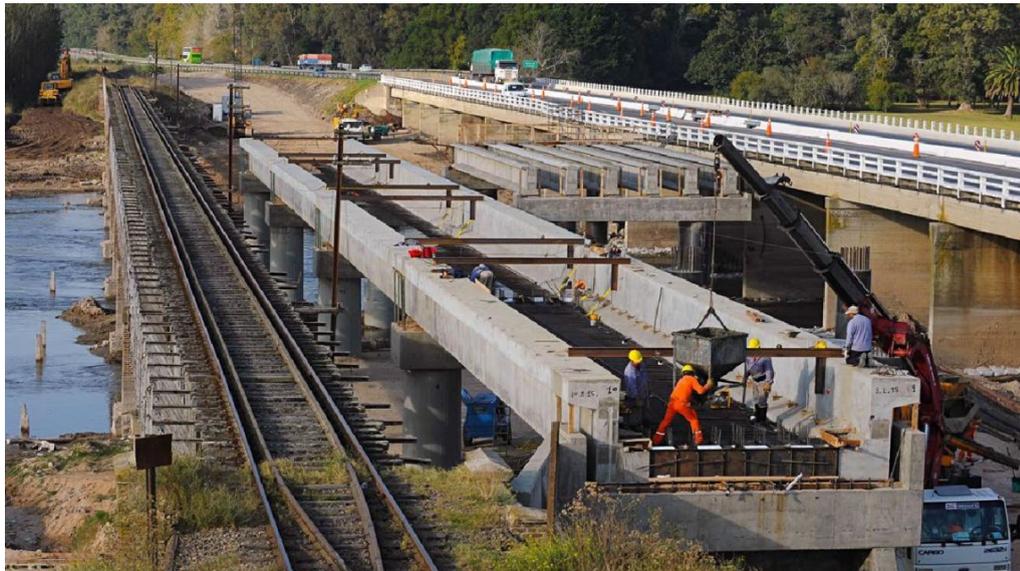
Hormigonado de Losa “in situ” postesada para conformación de sección “U”.
